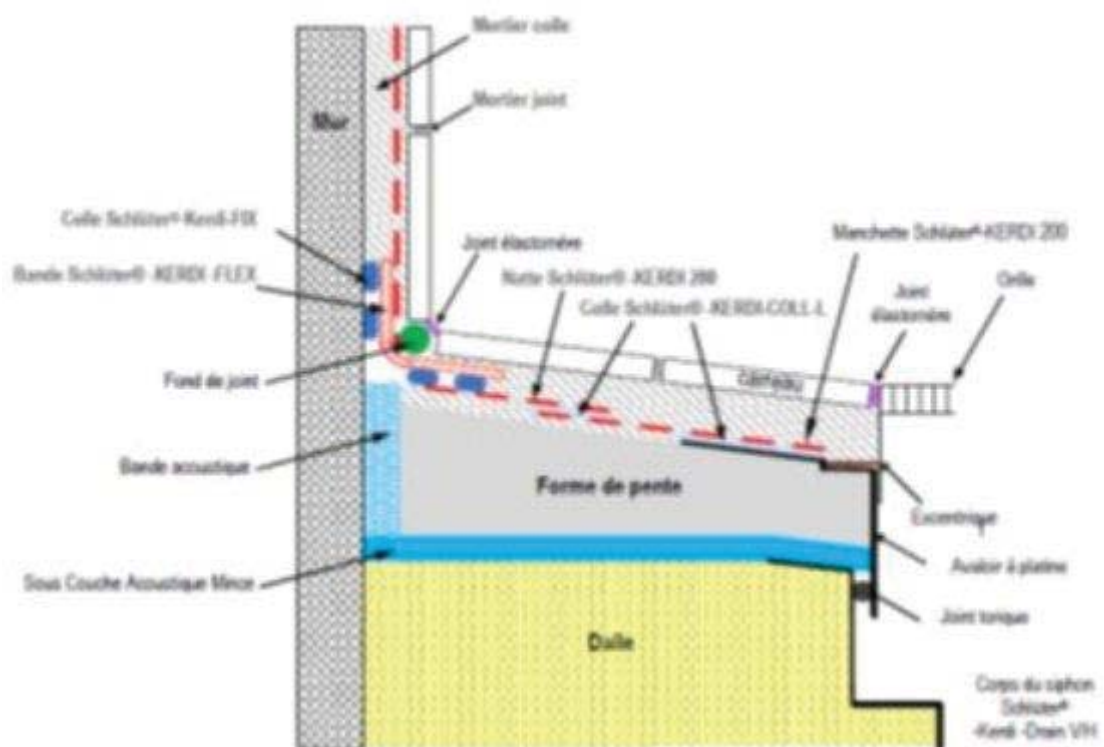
Raccordement sol-mur en pose collée – cas sur sous-couche mince
